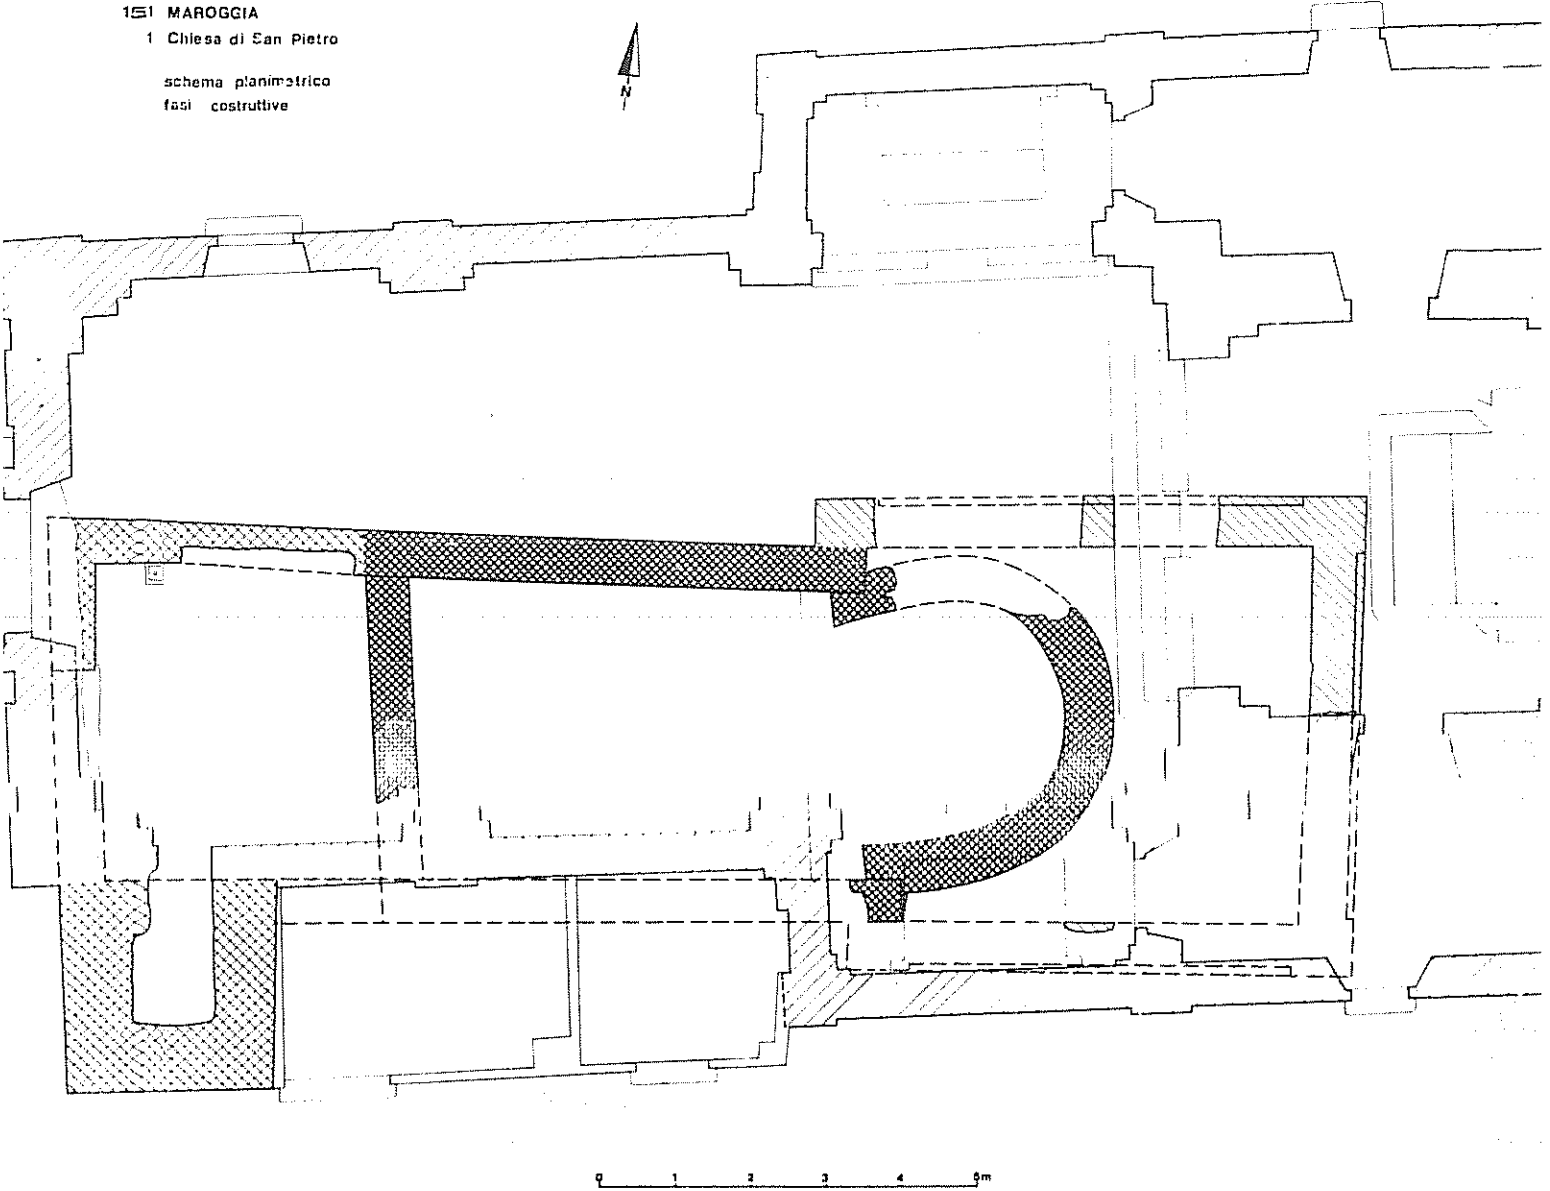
MAROGGIA - Chiesa di San Pietro. Planimetria di scavo.
